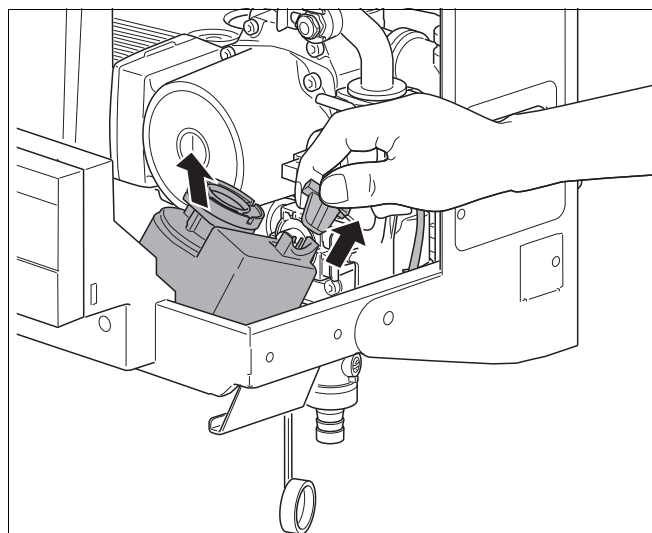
Steckkontakt vom Motor des internen Dreiwegeventils abziehen
